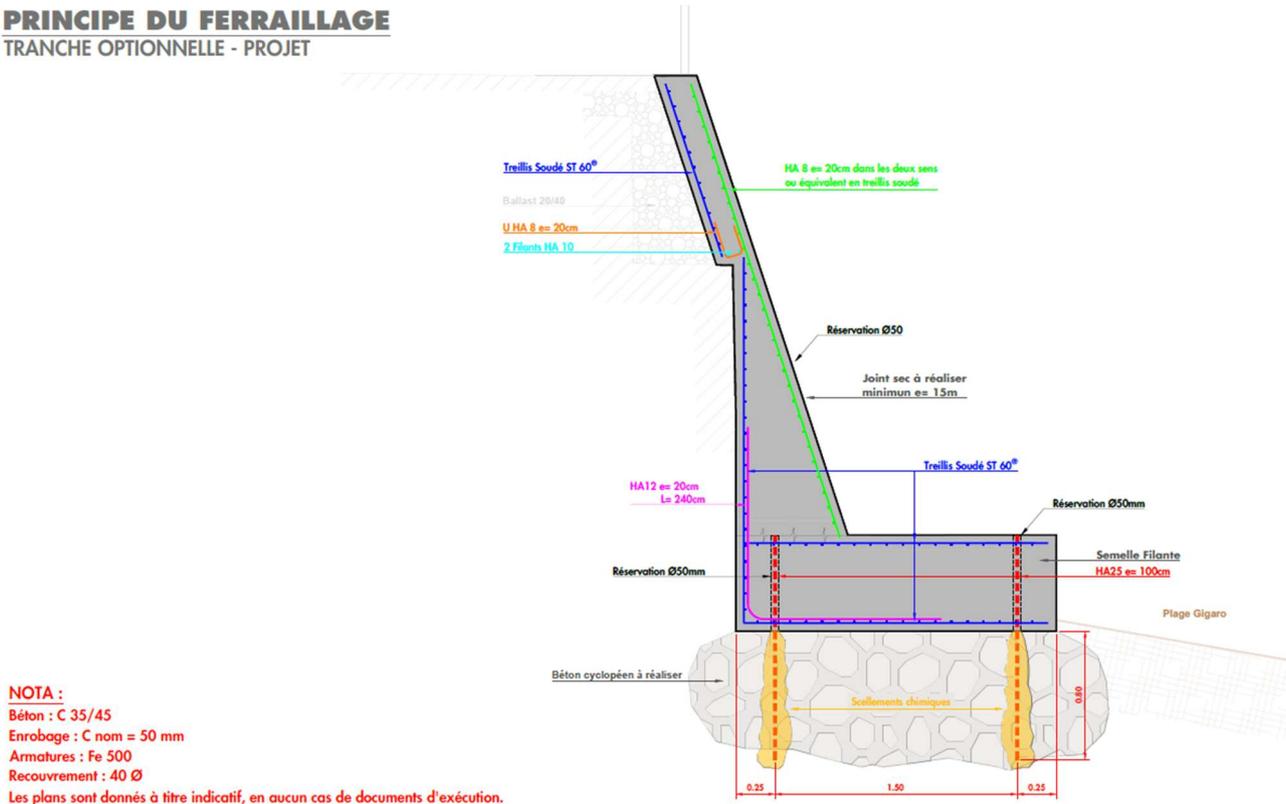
Coupe de principe présentant la conception structurelle de l'ouvrage (armatures de béton armé comprises)
